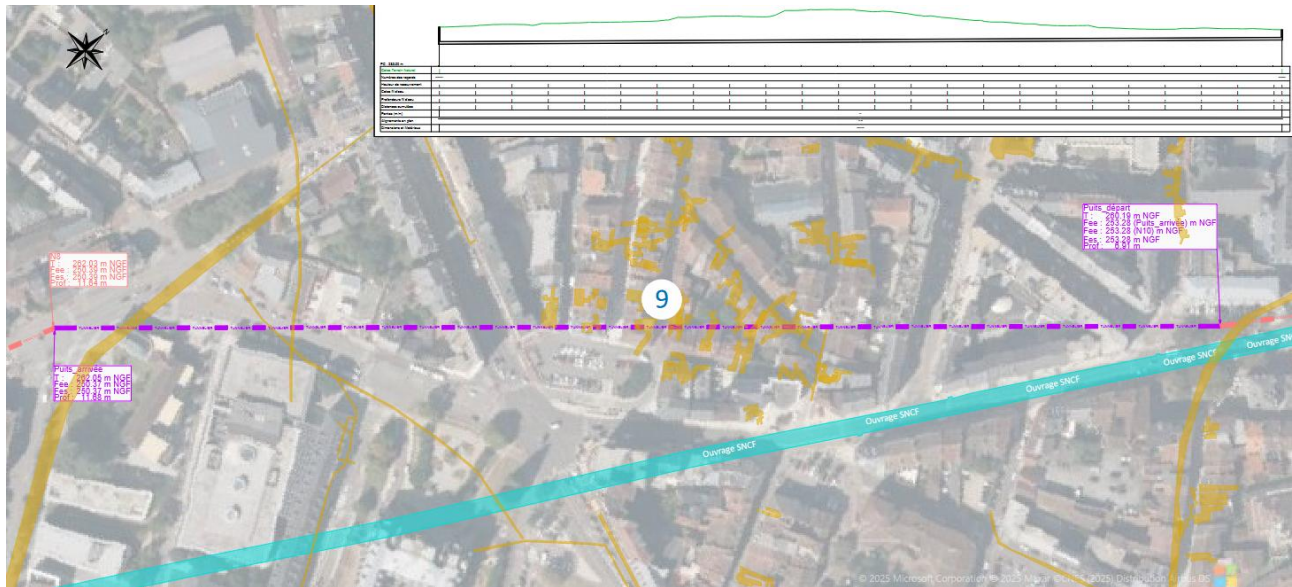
Plan du tunnel - Secteur Place Wilson - Louis Blanc
